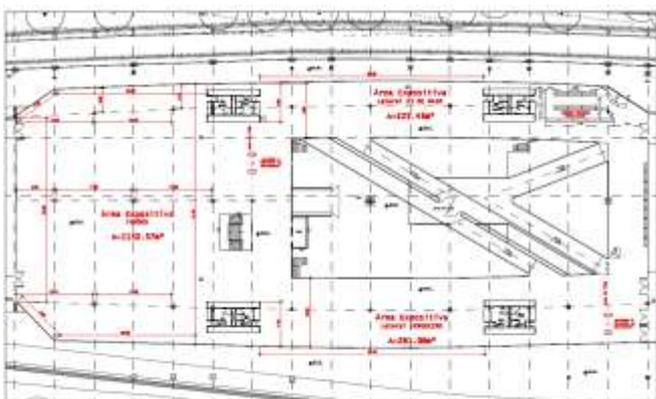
e 62: Planta e rampas de acesso ao Piso Caio Graco (respectivamente)
